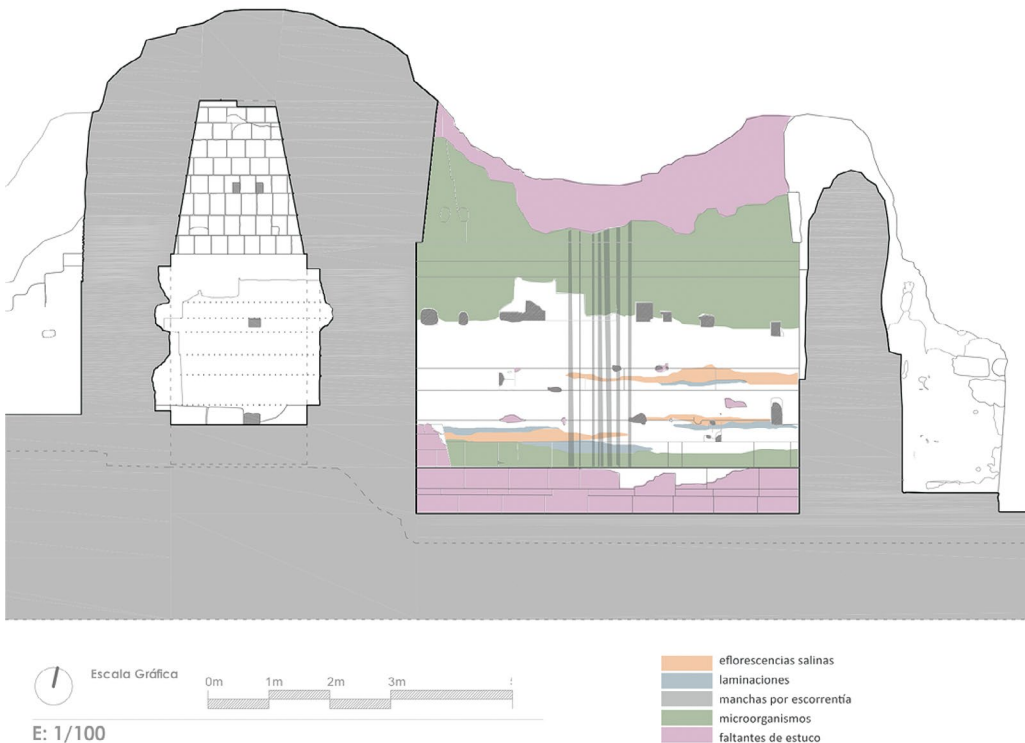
Ejemplo de croquis de daños muro N 6J2-4. Basado en plano de levantamiento arquitectónico del Proyecto La Blanca (Muñoz G., Matarredona N. y Marín B. 2007), modificado por la autora.
